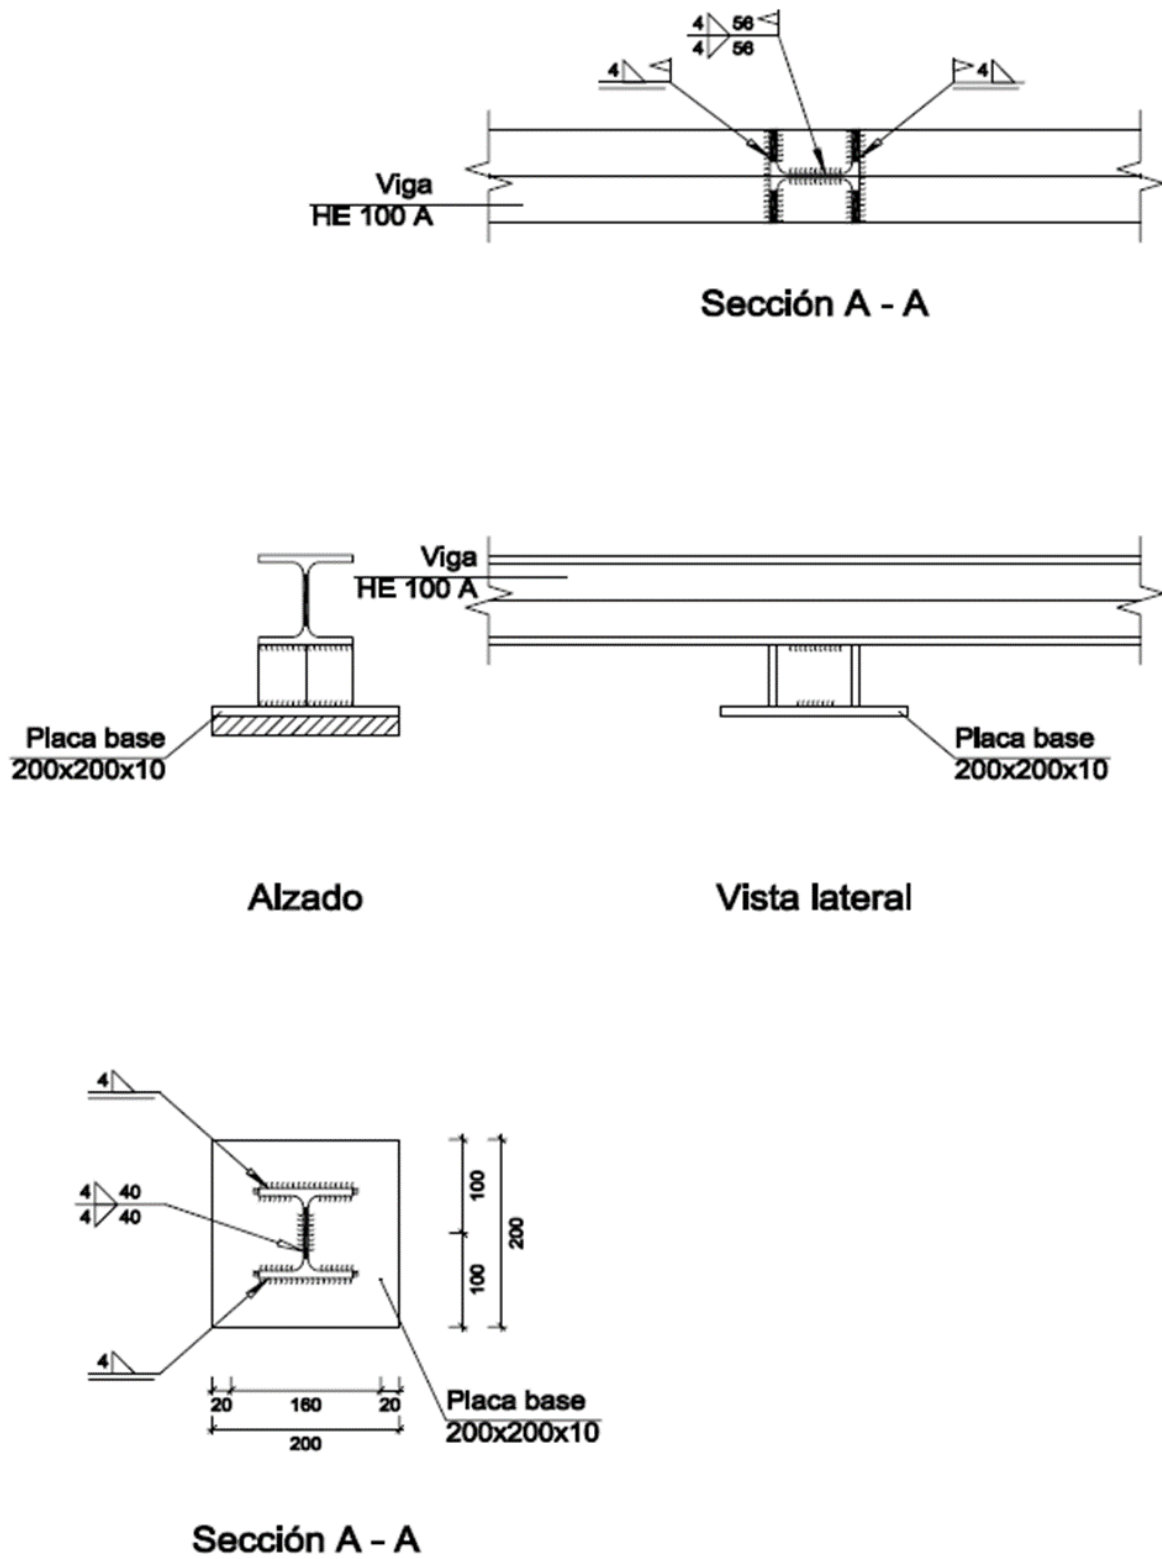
Detalle de la placa de apoyo que no va anclada a la losa.
